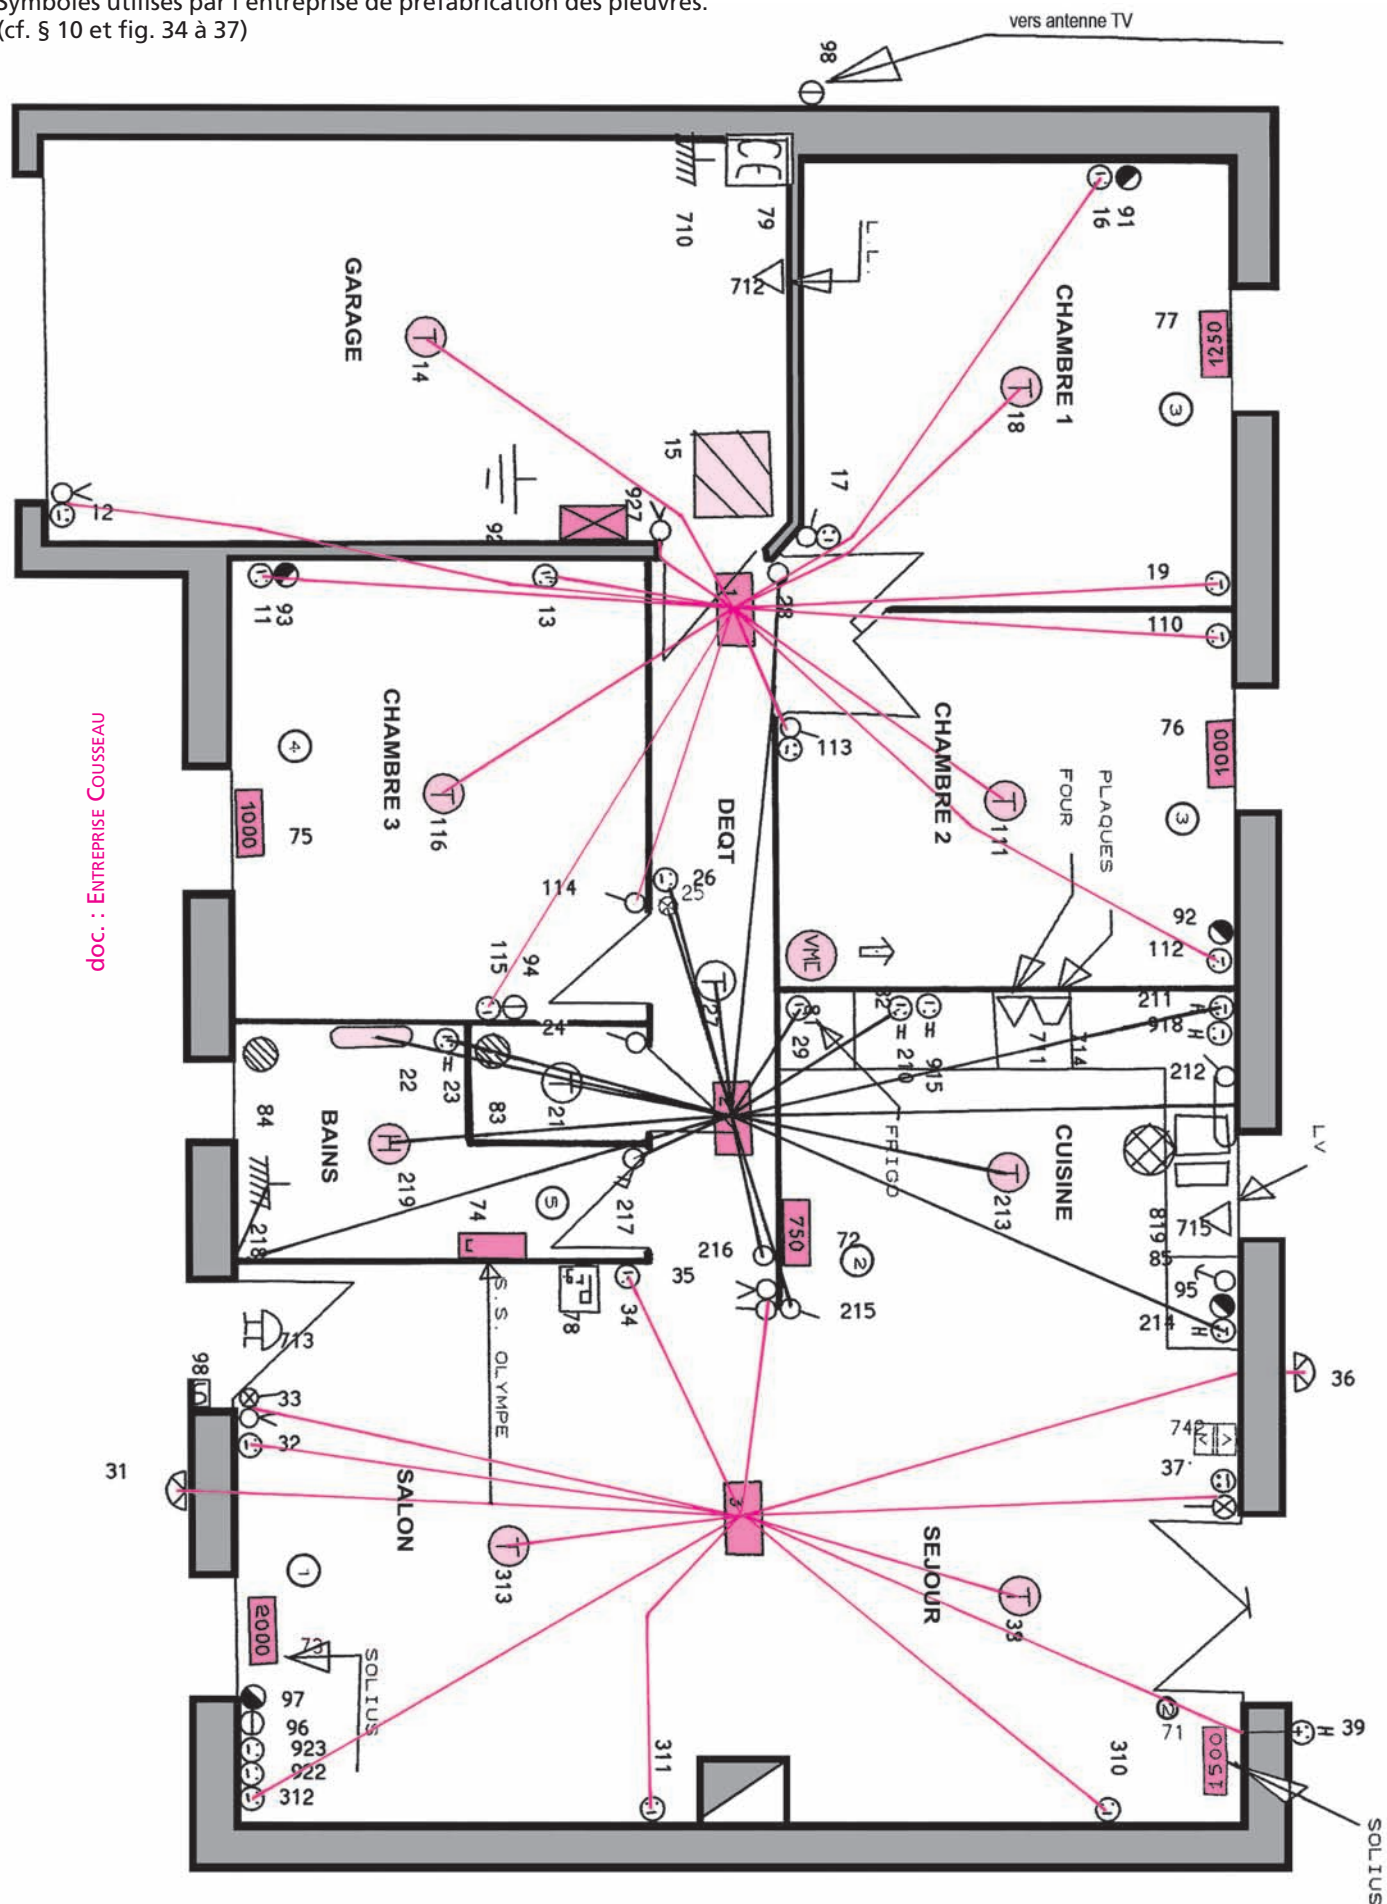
Mise en place de 3 pieuvres avec repérage des conduits
